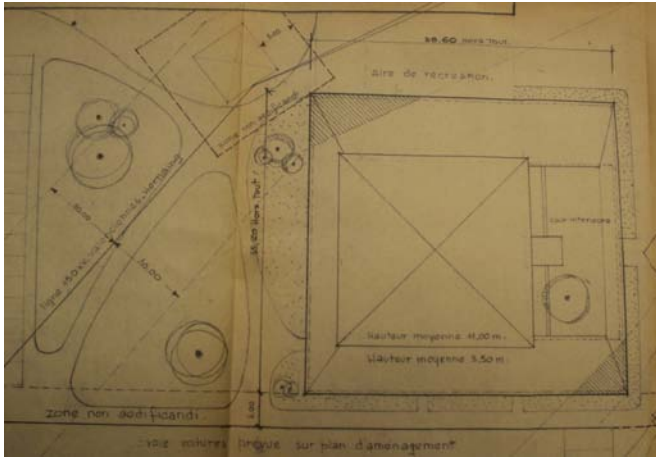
Plan de masse 20-12-76 (AD Cambrai Dossier de Permis de construire)
